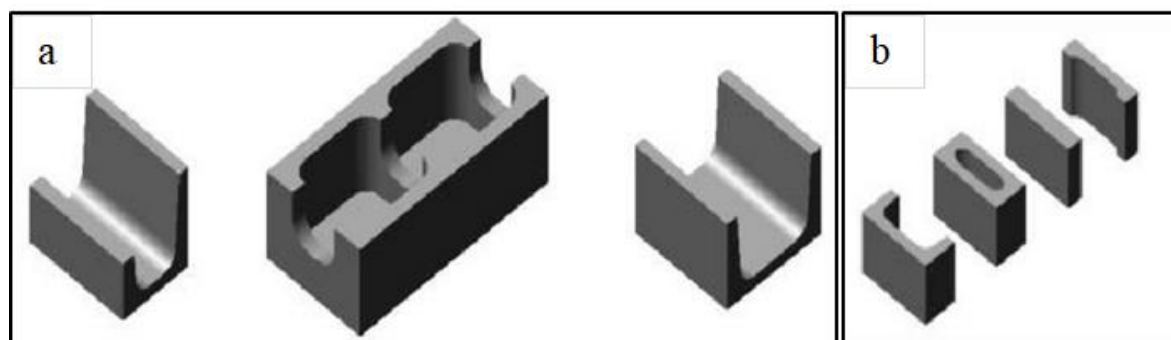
Detalhes da alvenaria de bloco de concreto.
